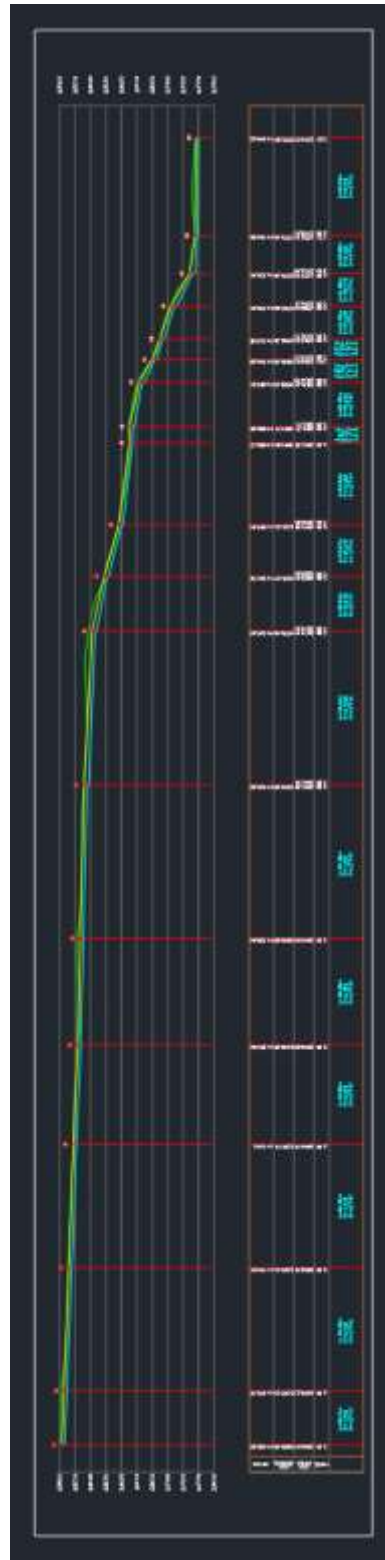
Trazado vista perfil nuevo alcantarillado Vereda las Cruces.
